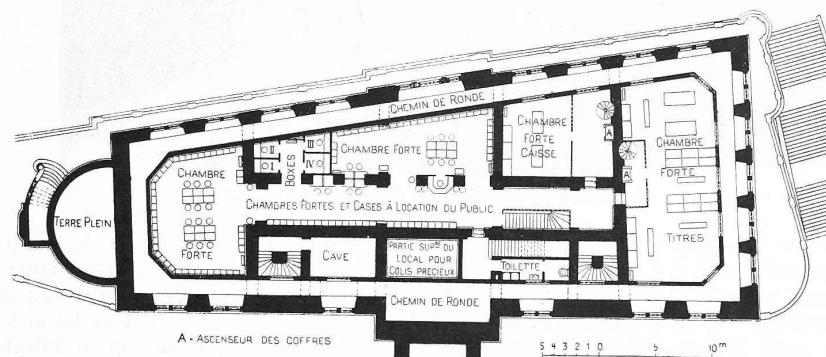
Plan du premier sous-sol. — Echelle 1 : 600.
